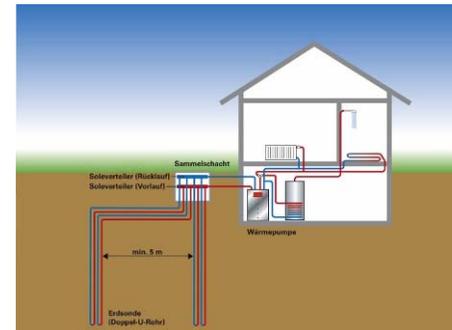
Schema einer Wärmepumpen-Heizung mit Erdsonden
